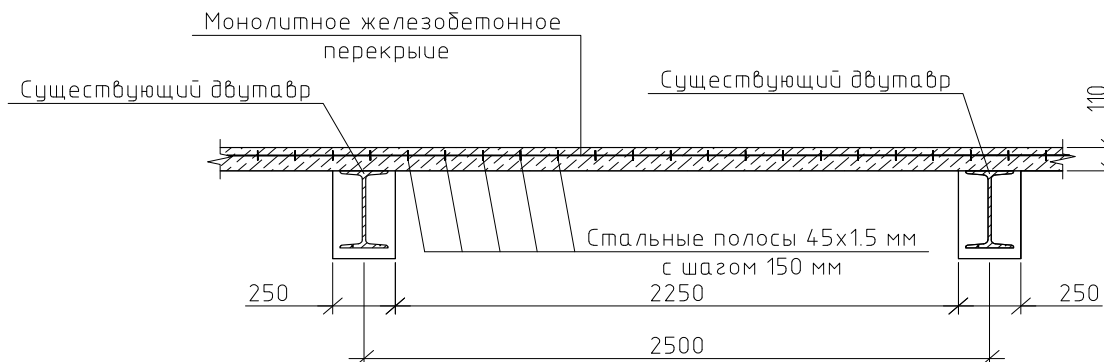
Схема железобетонного перекрытия (разработал Н.К. Ананьева)
